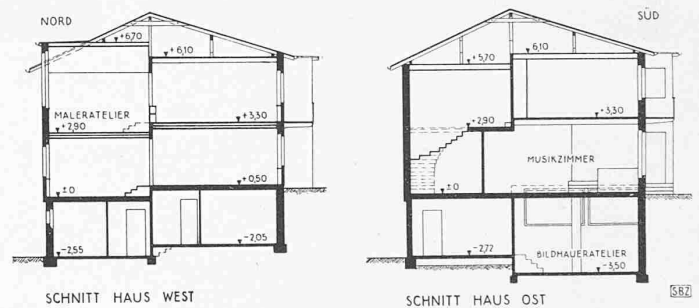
Querschnitte senkrecht zur Dachfirst. — 1:300
